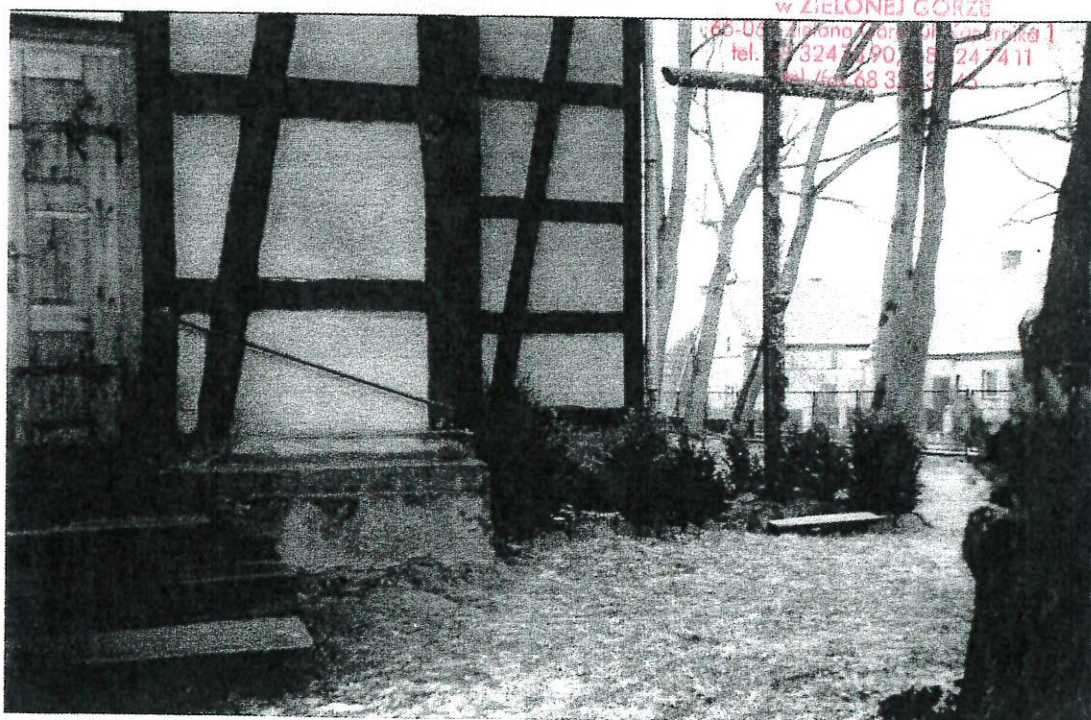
strefa wschodnia zabudowy budynku kościoła, część cokołowa. widoczny brak podwaliny w konstrukcji szachulcowej trzonu wieży.
